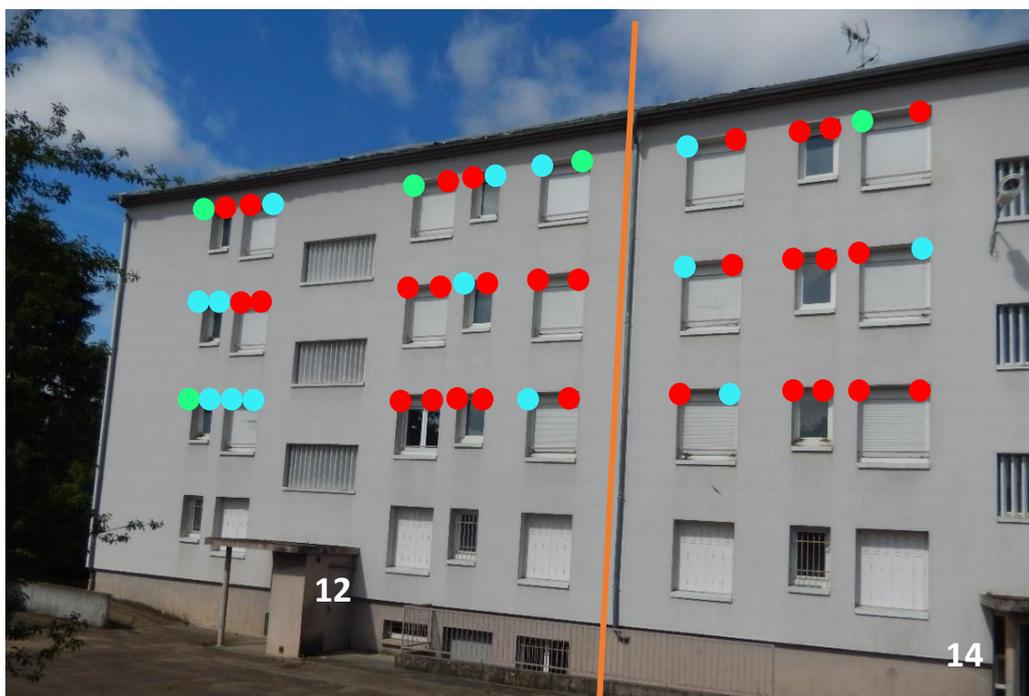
Façade avant du bâtiment 12 et façade gauche du bâtiment 14
